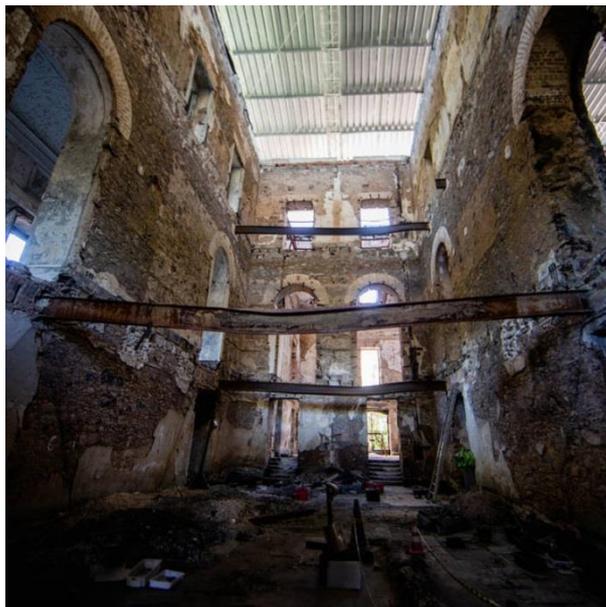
Foto após o incêndio das vigas metálicas retorcidas que sobraram entre os pavimentos.
